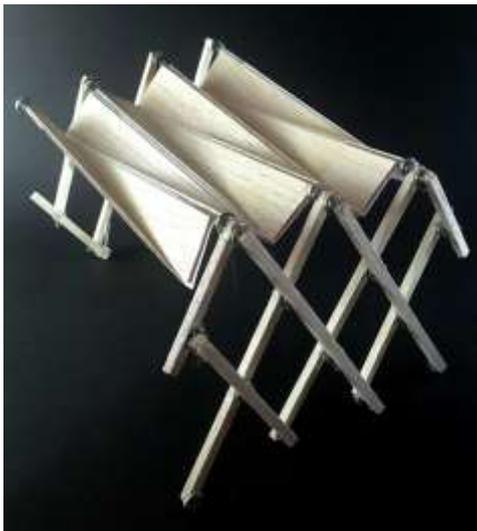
Detalle de las uniones articuladas entre la malla estructural y la cobertura.
